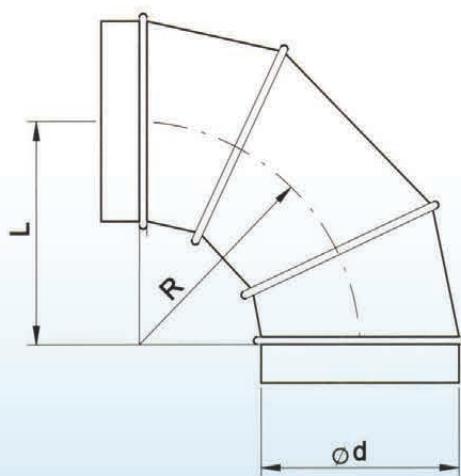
Габаритный чертеж отвода (из трех сегментов)
